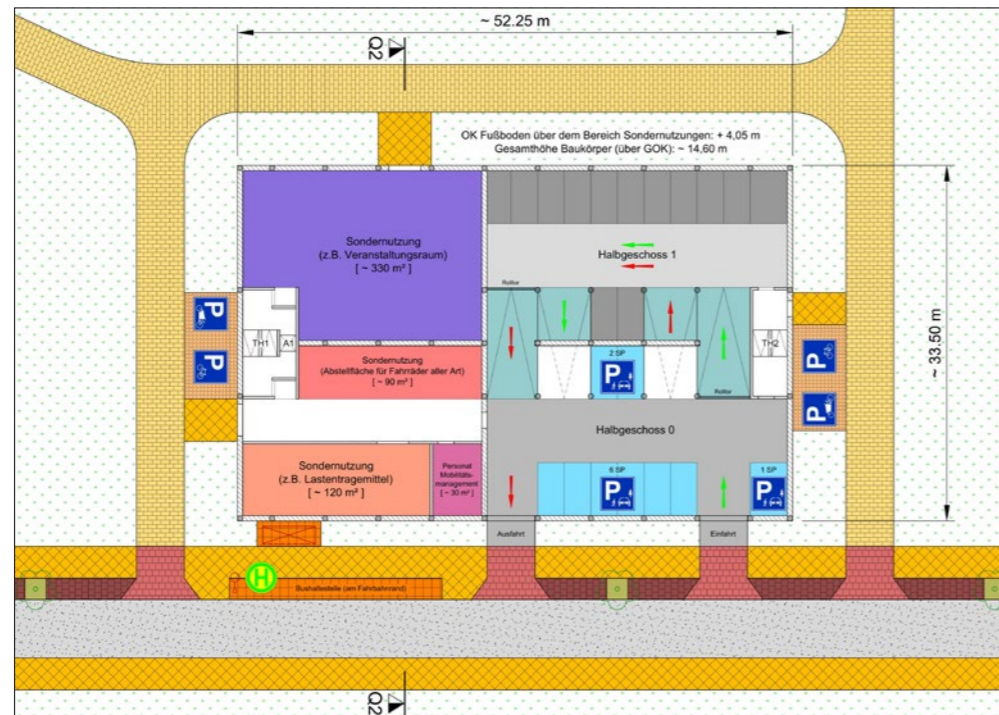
Planskizze des Erdgeschosses einer Bewohnersammelgarage mit Mobilitätszentrale
